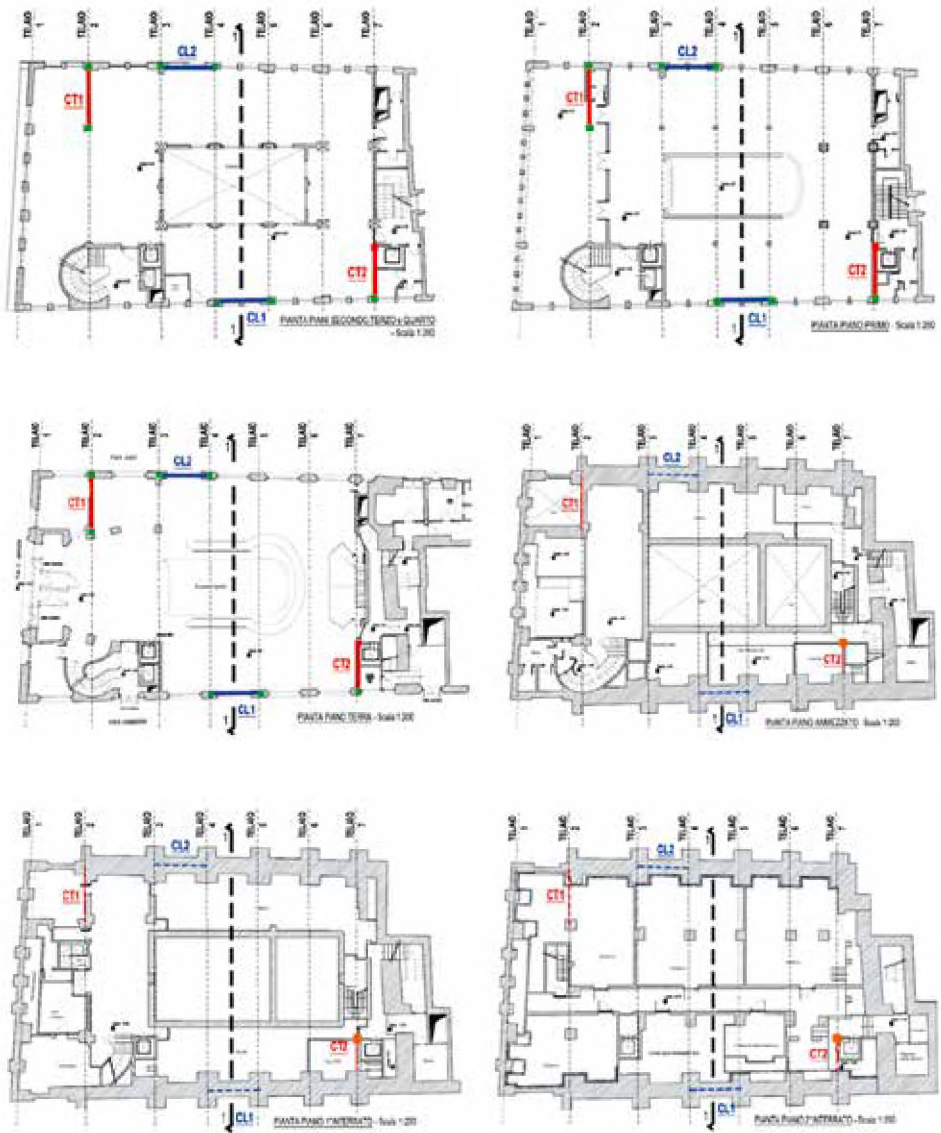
Disposizione in pianta dei controventi dissipativi BRB
